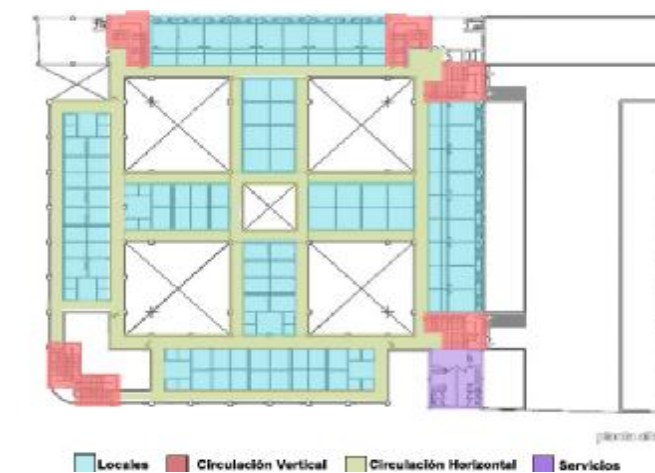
PLANTA ALTA DEL MERCADO 3 DE NOVIEMBRE
